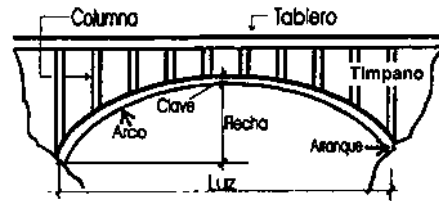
Puente en arco con tablero superior. (CuevadelCivil, 2013)
